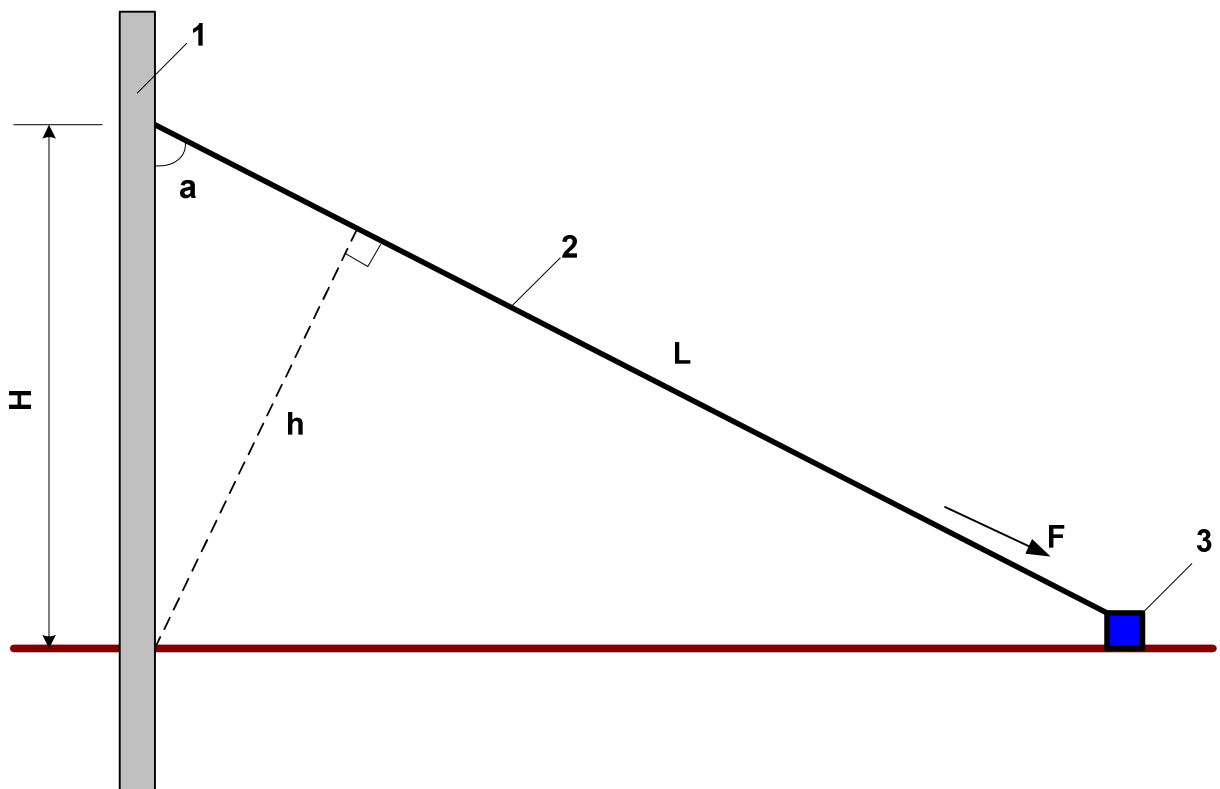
Схема испытания железобетонной стойки в полевых условиях
